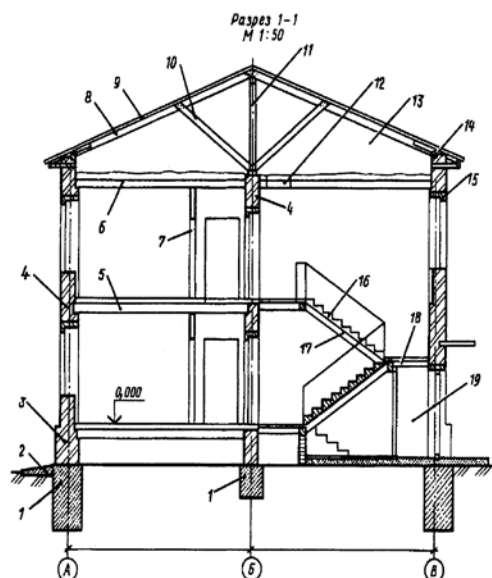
Конструктивные элементы здания с несущими стенами:
